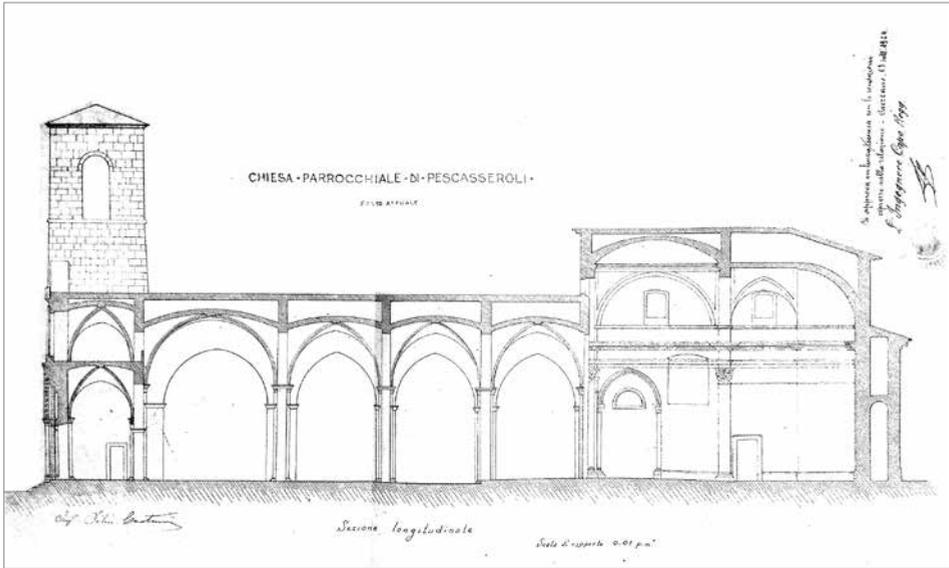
Pescasseroli, rilievo della chiesa dei Santi Pietro e Paolo (Archivio di Stato di Avezano, Sezione Genio Civile, b. 84, G. Buttarelli «Progetto di restauro della chiesa parrocchiale di Pescasseroli. Proposta di variante nell'esecuzione del progetto approvato. Relazione Tecnica»)
